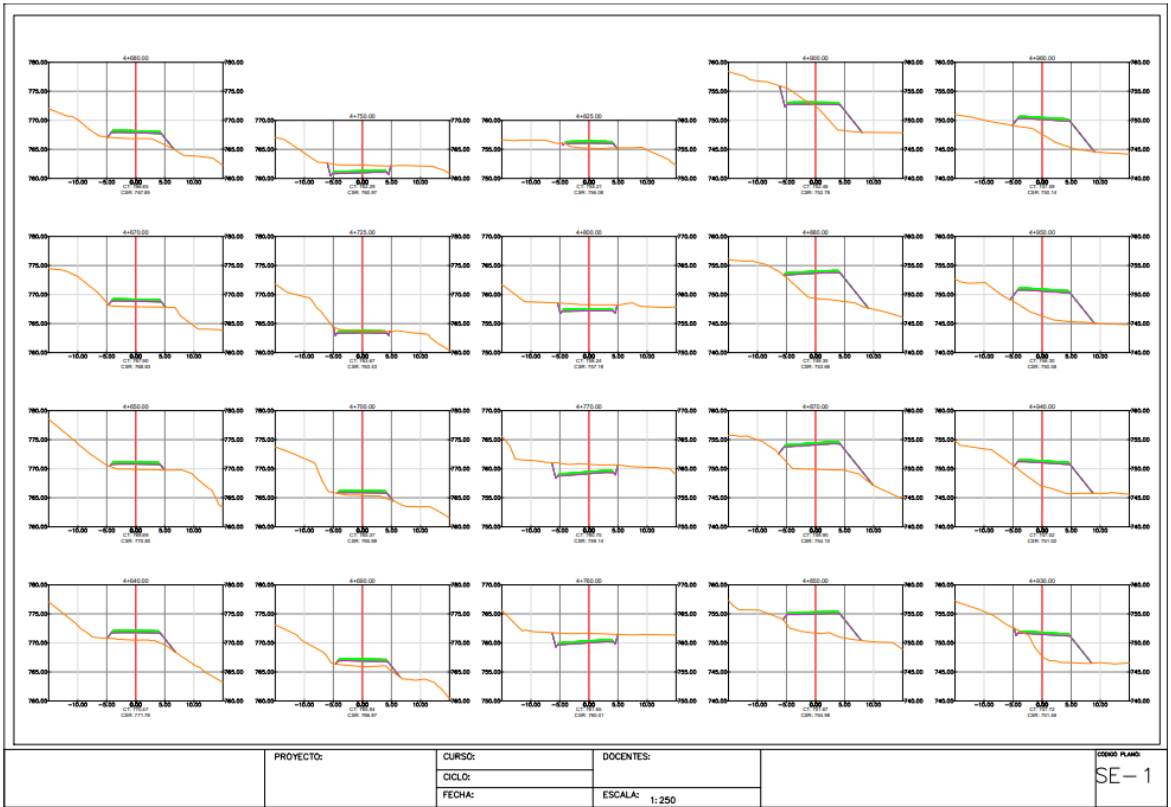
Primera parte de las secciones de corte y relleno en civil 3D.
